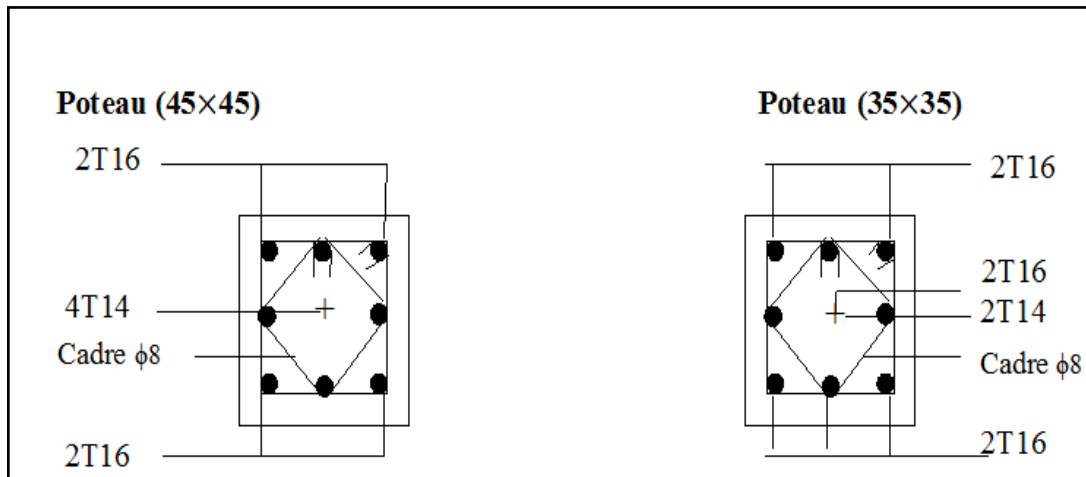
Ferrailage des poteaux du bloc B2.
